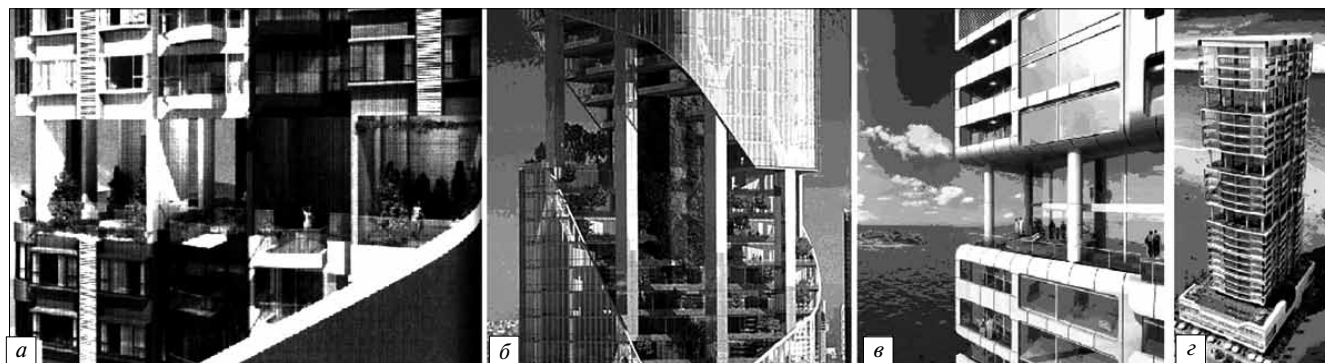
Зеленые («небесные») сады в небоскребах: высотой на этаж (а); на несколько этажей (б); открытые (в); без наружных стен (г)
